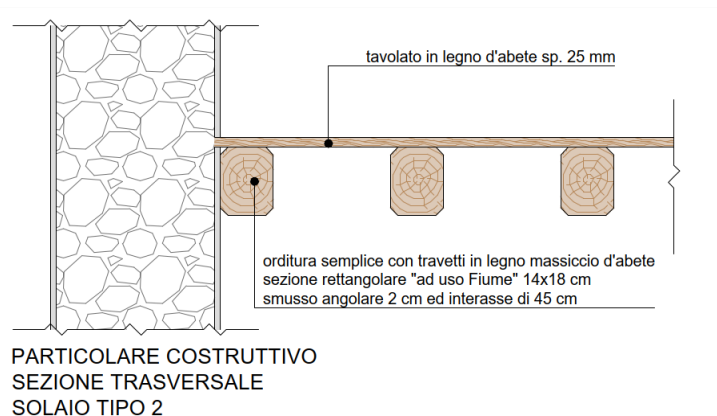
Particolare costruttivo Solaio tipologia 2 - Sezione trasversale
